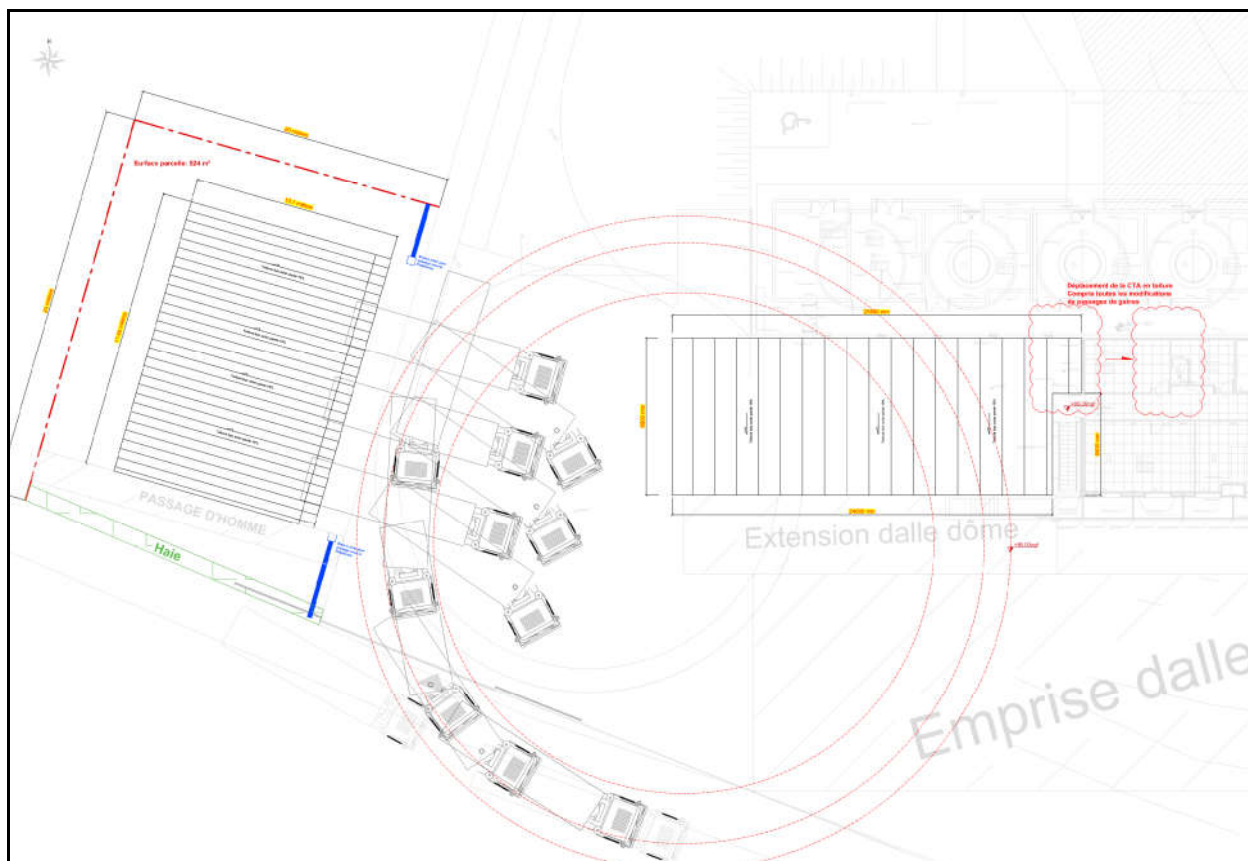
Extrait plan de masse du projet, ESCAMEZ
